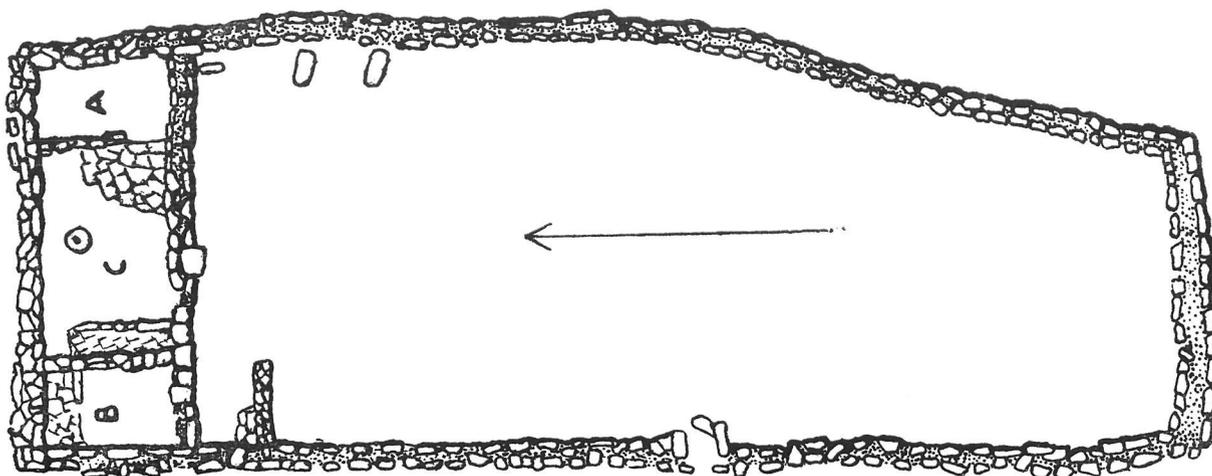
Planta de la casa n.º 3 de la "Lancha del Trigo", Diego Alvaro (Avila). Escala 1/400.
